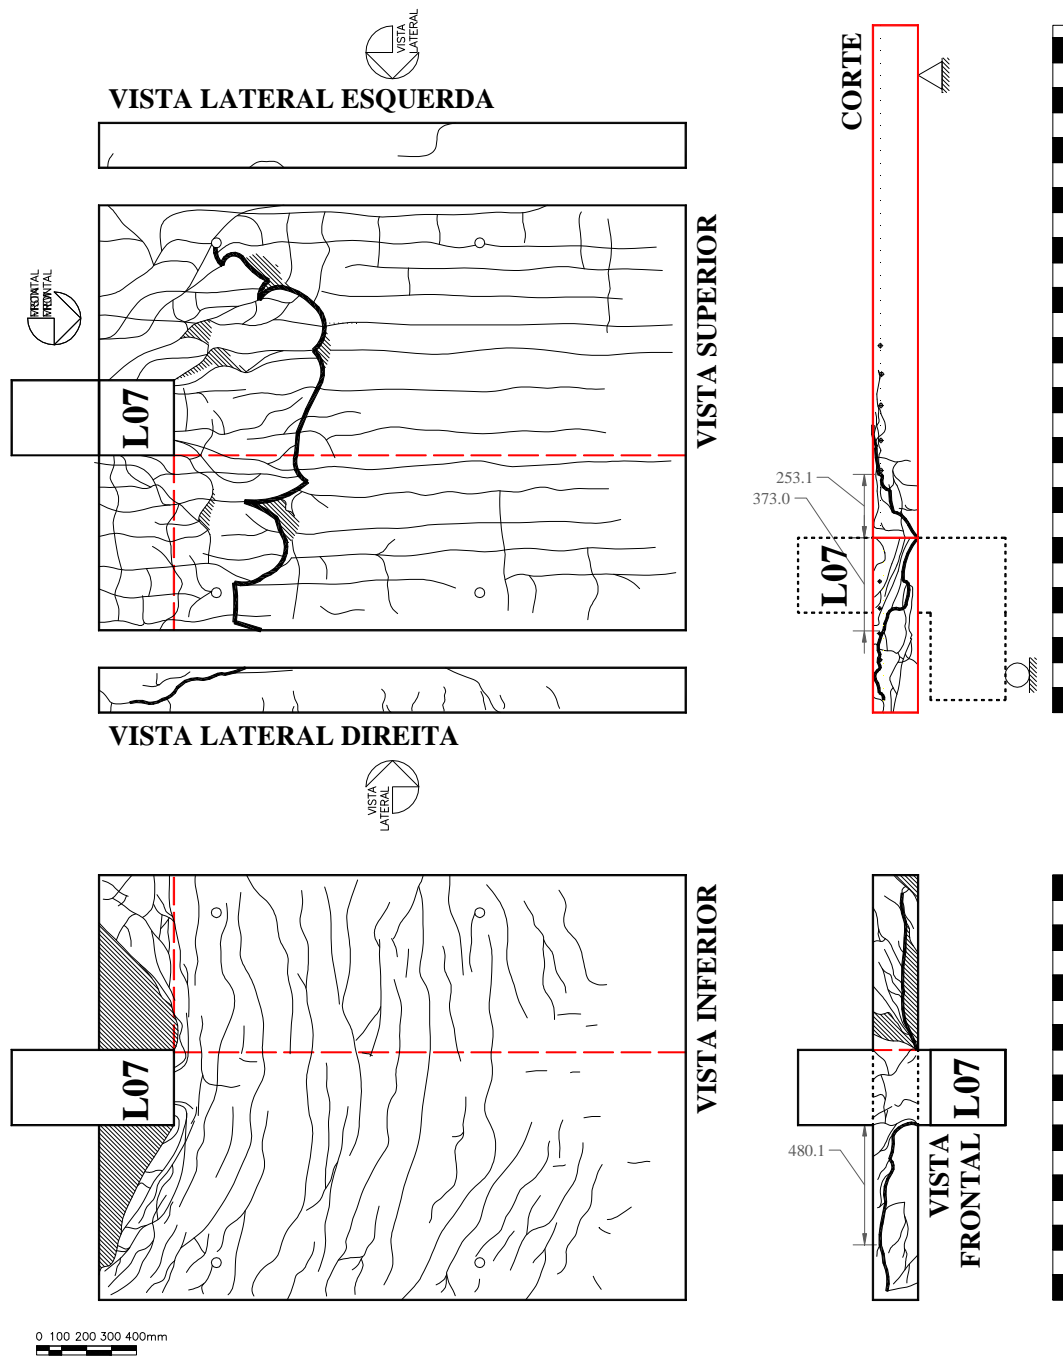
Padrão de fissuração da laje L07
